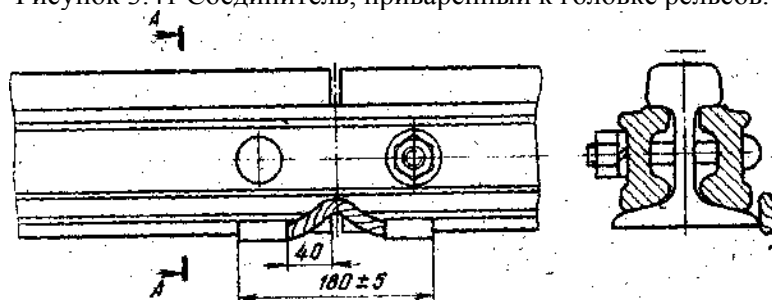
Соединитель, приваренный к верхней грани подошвы объемнозакаленных рельсов типа Р65 и Р75.
